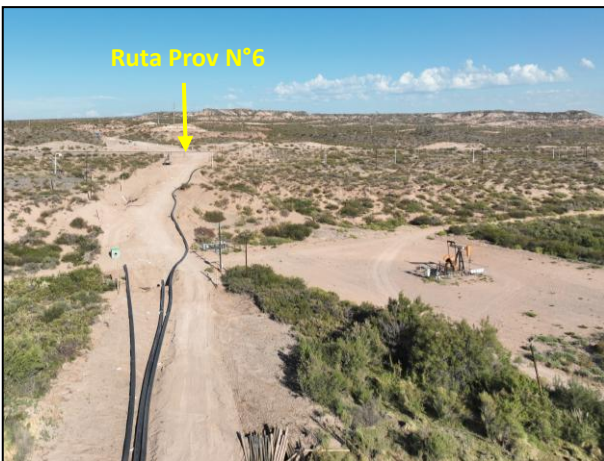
y 10. Picada y ductos flexibles pasando al sur de locación DB-178 y llegando a RP6.
